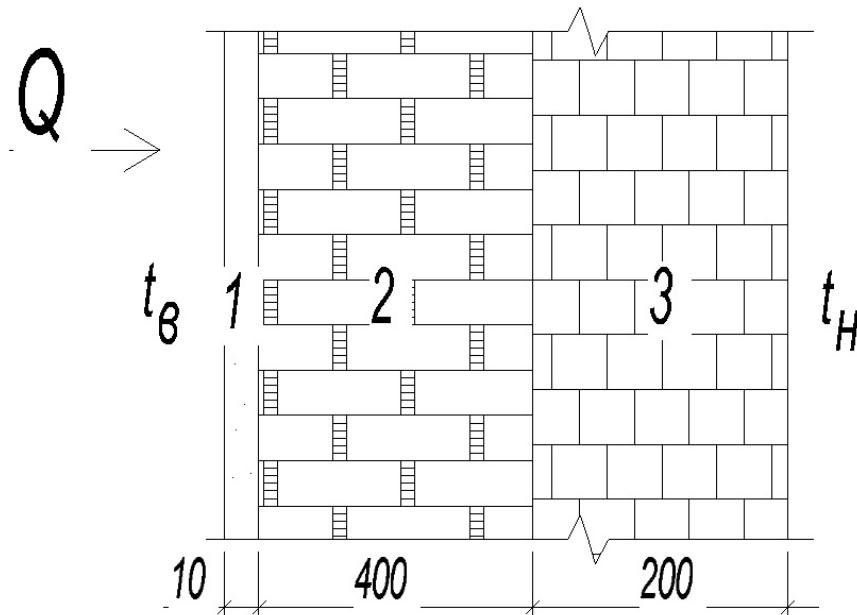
Исходная конструкция наружной стены первого этажа
